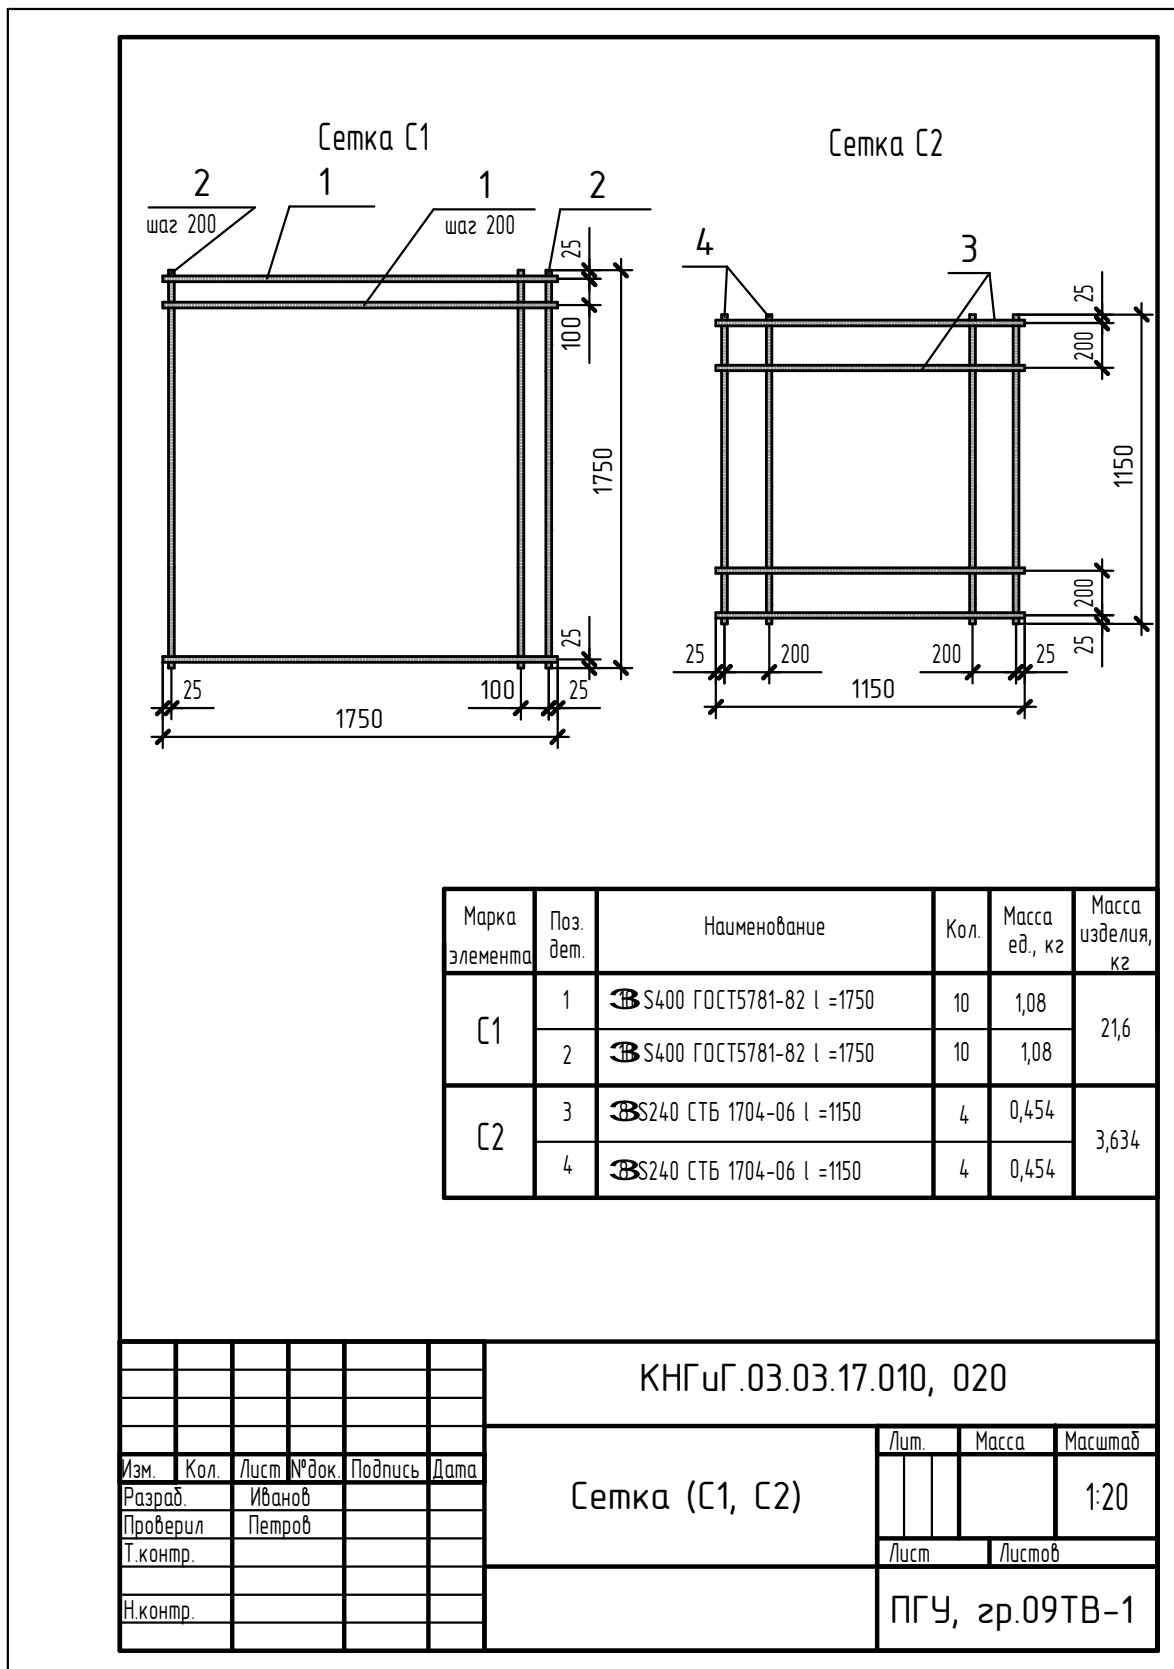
Рабочий чертеж арматурных сеток С1 и С2 для фундамента ФМ12
